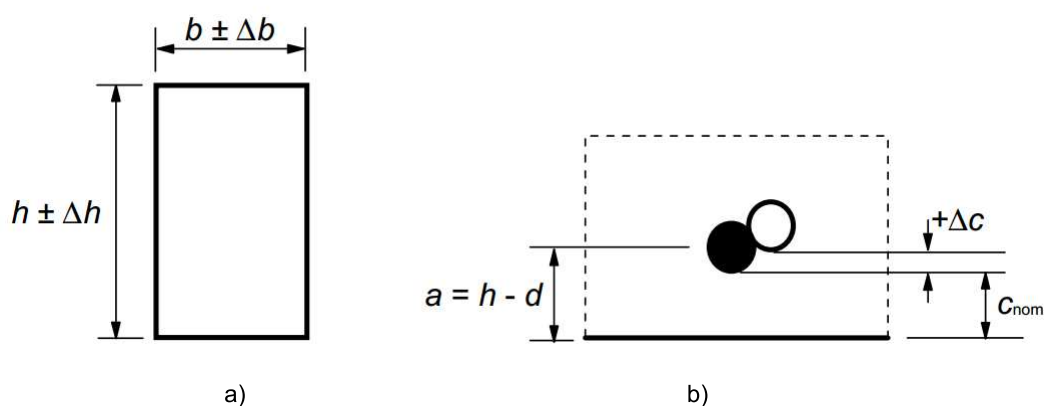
Aplicação da margem de imperfeição, a) secção transversal b) altura útil da armadura (adaptada do EC2)
